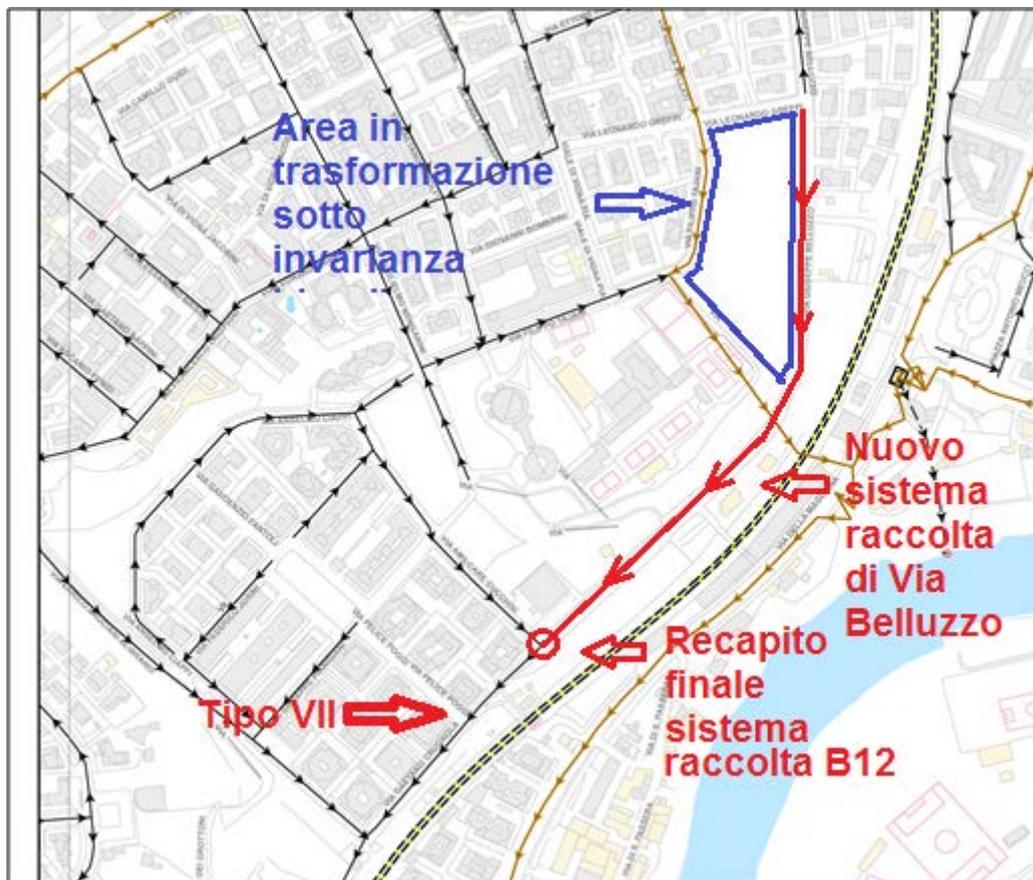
Planimetria generale dei Collettori [fonte originale ACEA ATO2]
